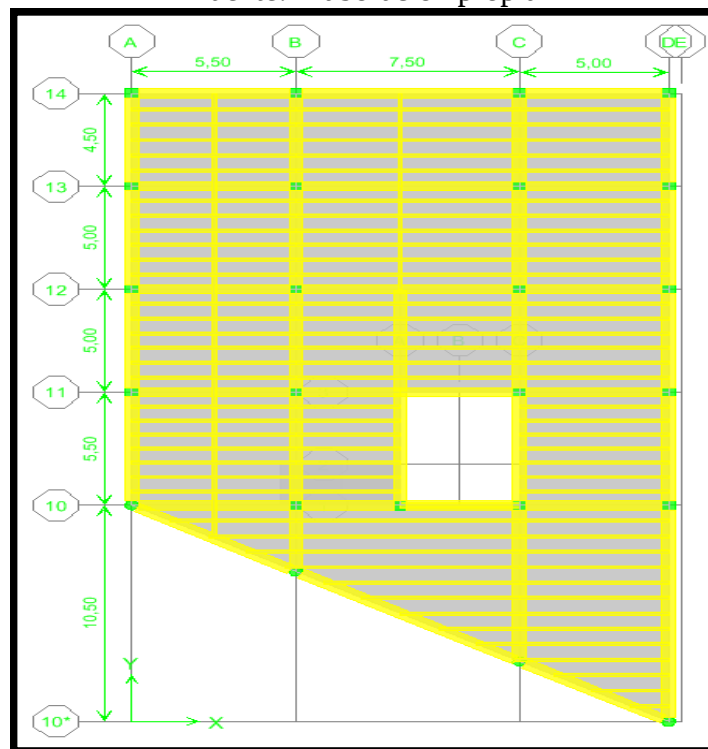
Planta de Nueva Configuración Módulo 4 (Edificio Norte).
